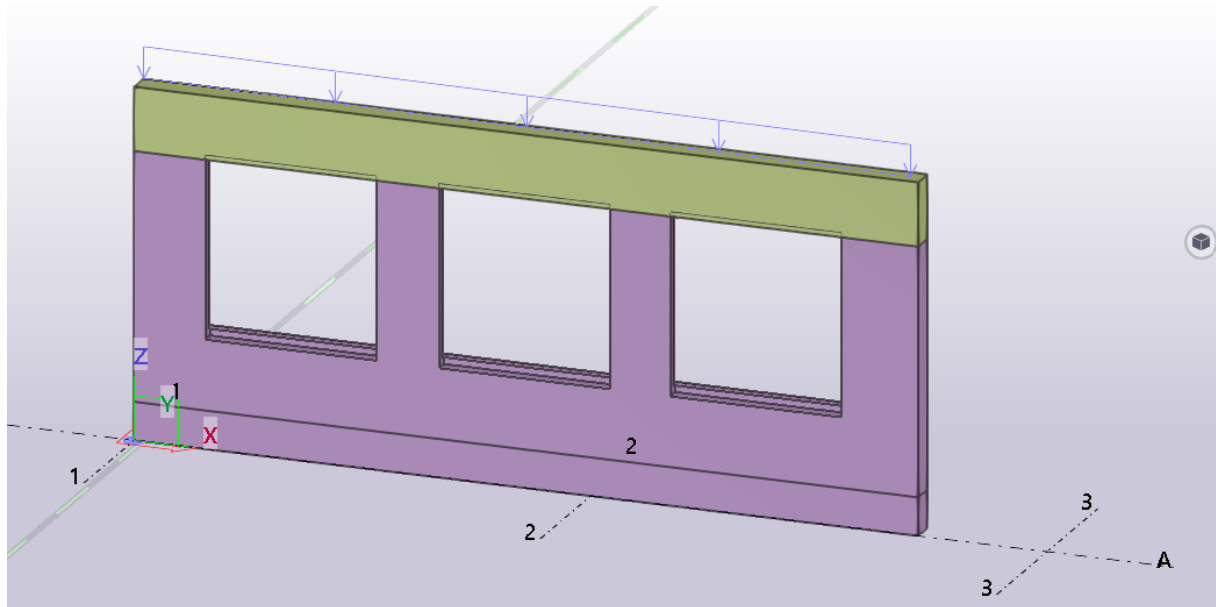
Façade Sud du bâtiment comprenant trois fenêtres
